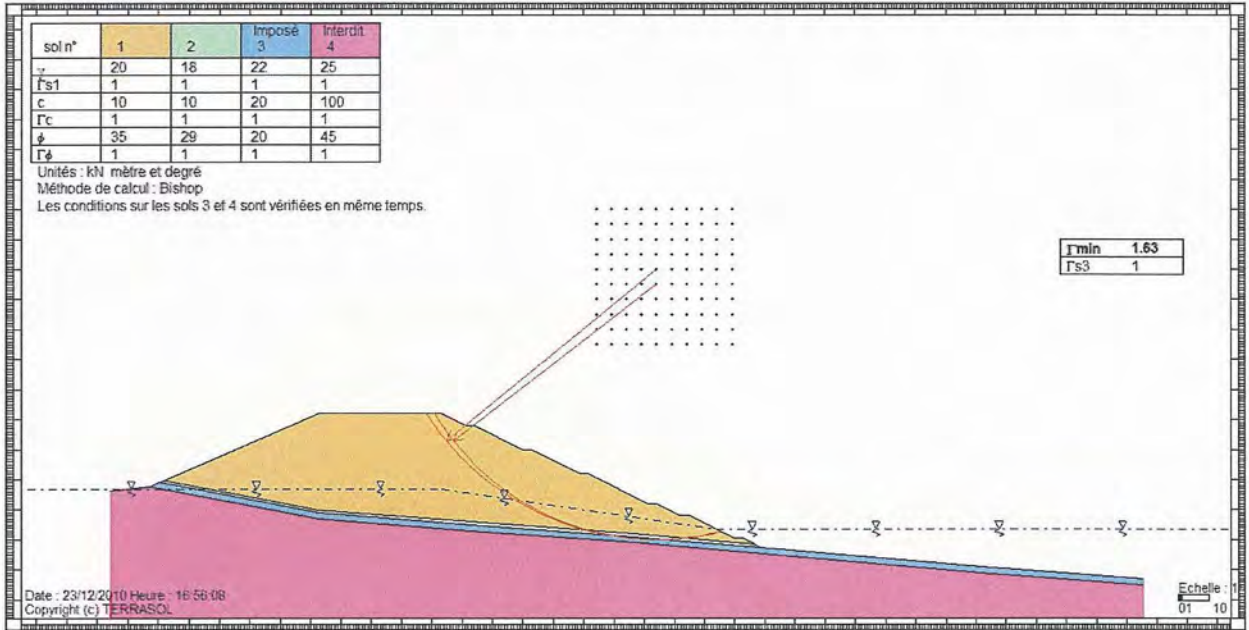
Coupe 1 : Stabilité vis-à-vis d'un glissement profond avec remontée accidentelle du niveau de la nappe
